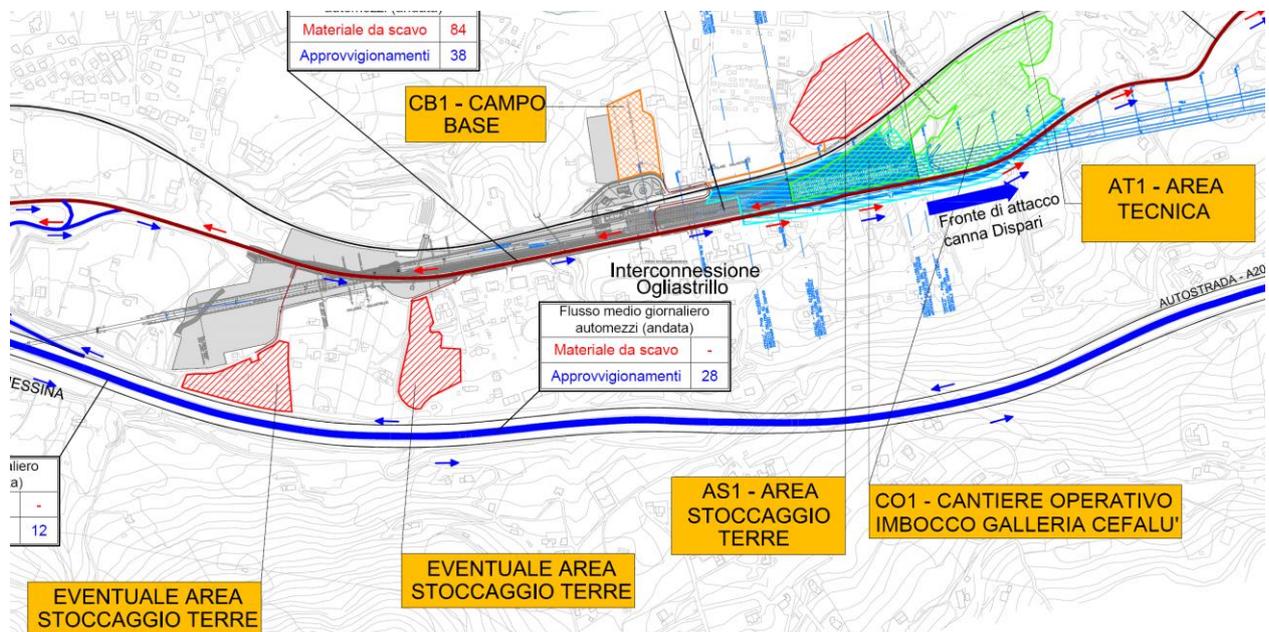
Stralcio planimetrico della Zona Ogliastrillo, con indicazione delle aree di cantierizzazione AS1, CB1, CO1 e di altre due eventuali aree di stoccaggio.
